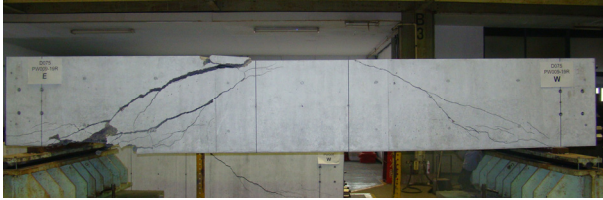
実験終了後のひびわれ状況 (D075PW009-19)
